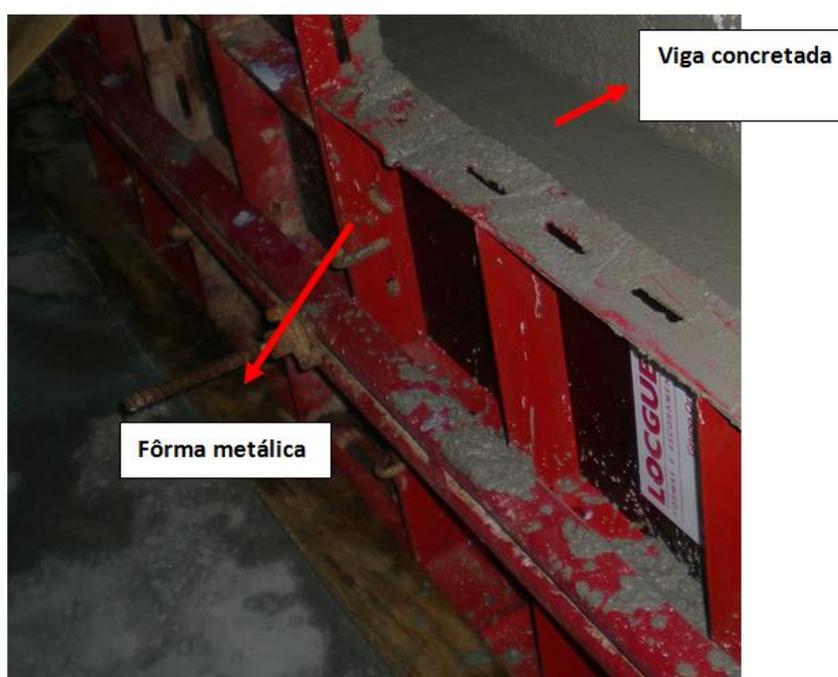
Viga concretada em fôrma metálica – Fonte: O autor
